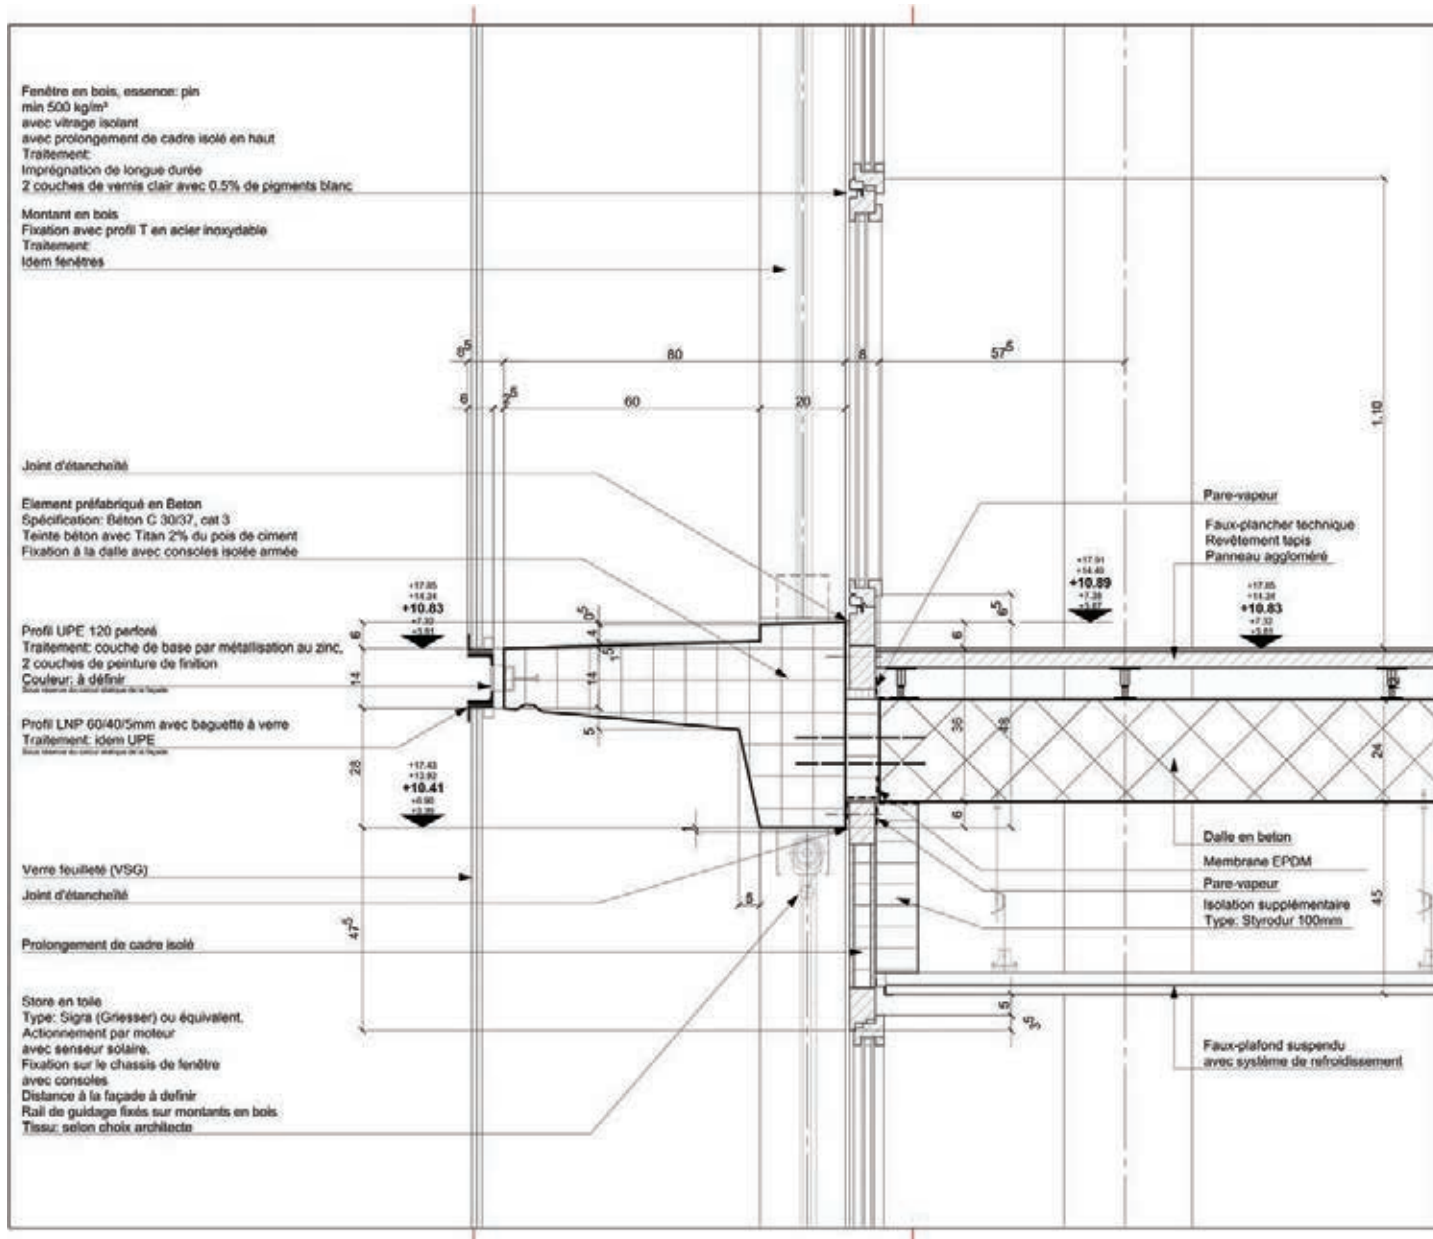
Stralcio progetto architettonico sezione verticale facciata a doppia pelle
